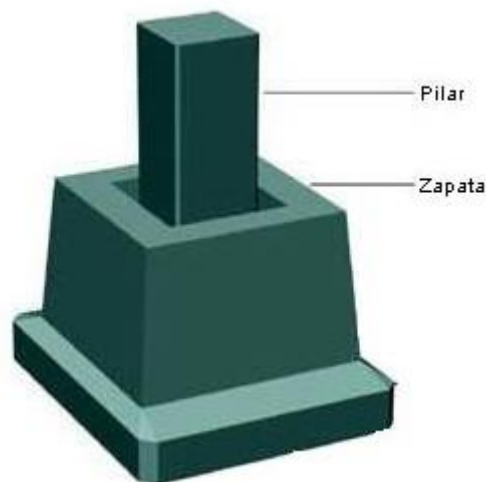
Ejemplo de zapata Fuente: Asignatura “Tipología estructural”
